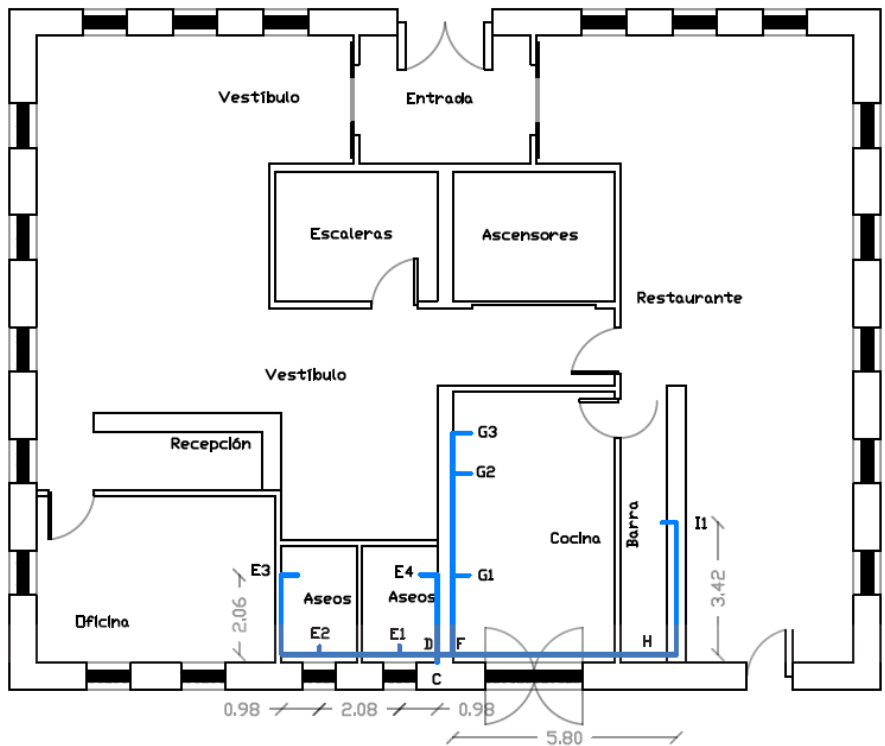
Plano de la red de suministro de agua de la planta baja. Fuente: Elaboración propia
